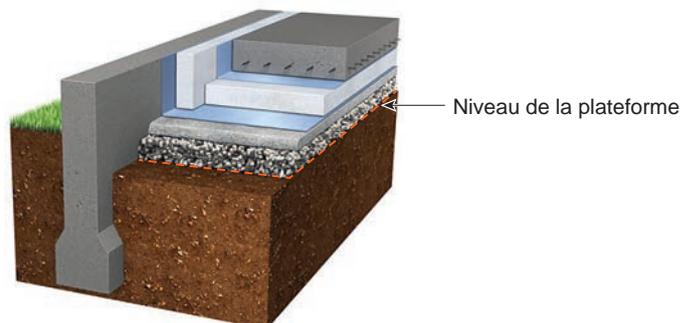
Niveau de la plateforme sans vide sanitaire
